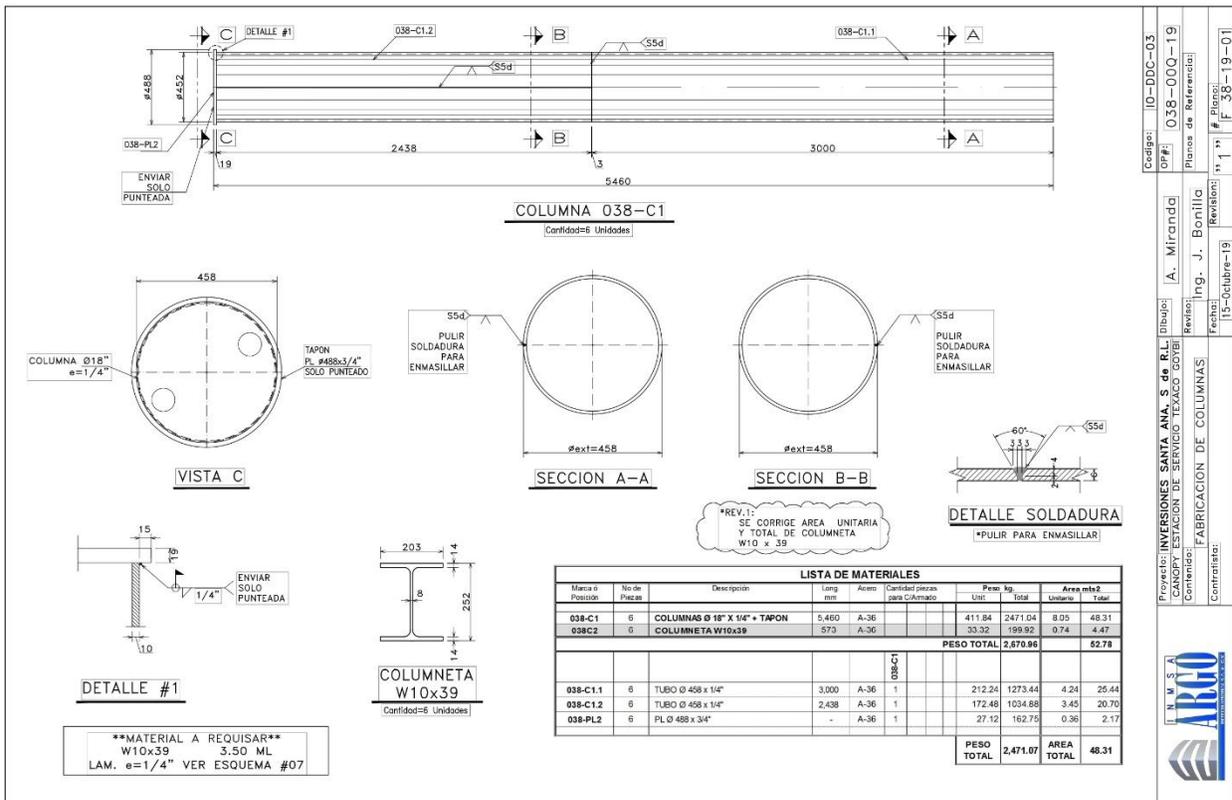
Plano de fabricación de columnas Ø18", Canopy mayor
